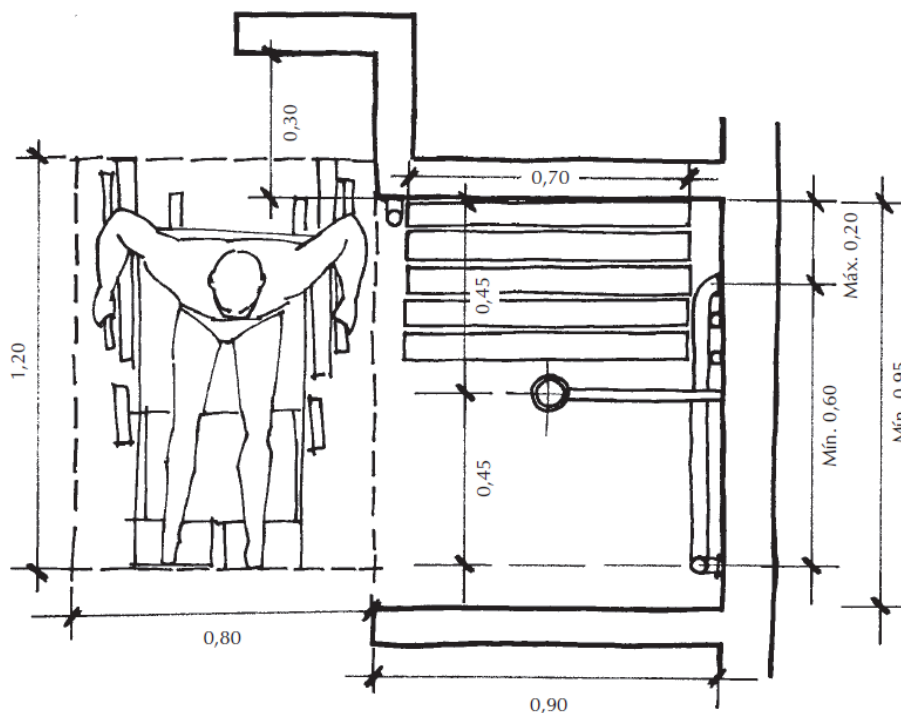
Área de transição para o box do chuveiro com barras verticais e horizontais (SMPED, 2008).
